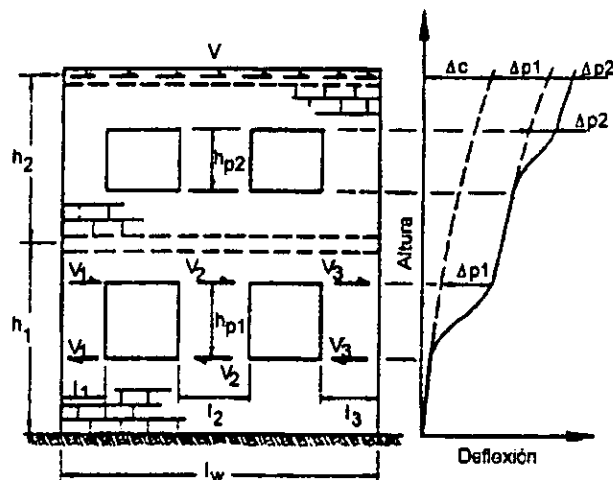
Deformaciones debidas a fuerzas laterales en un a estructura de mampostería con aberturas (Paulay and Priestley).
